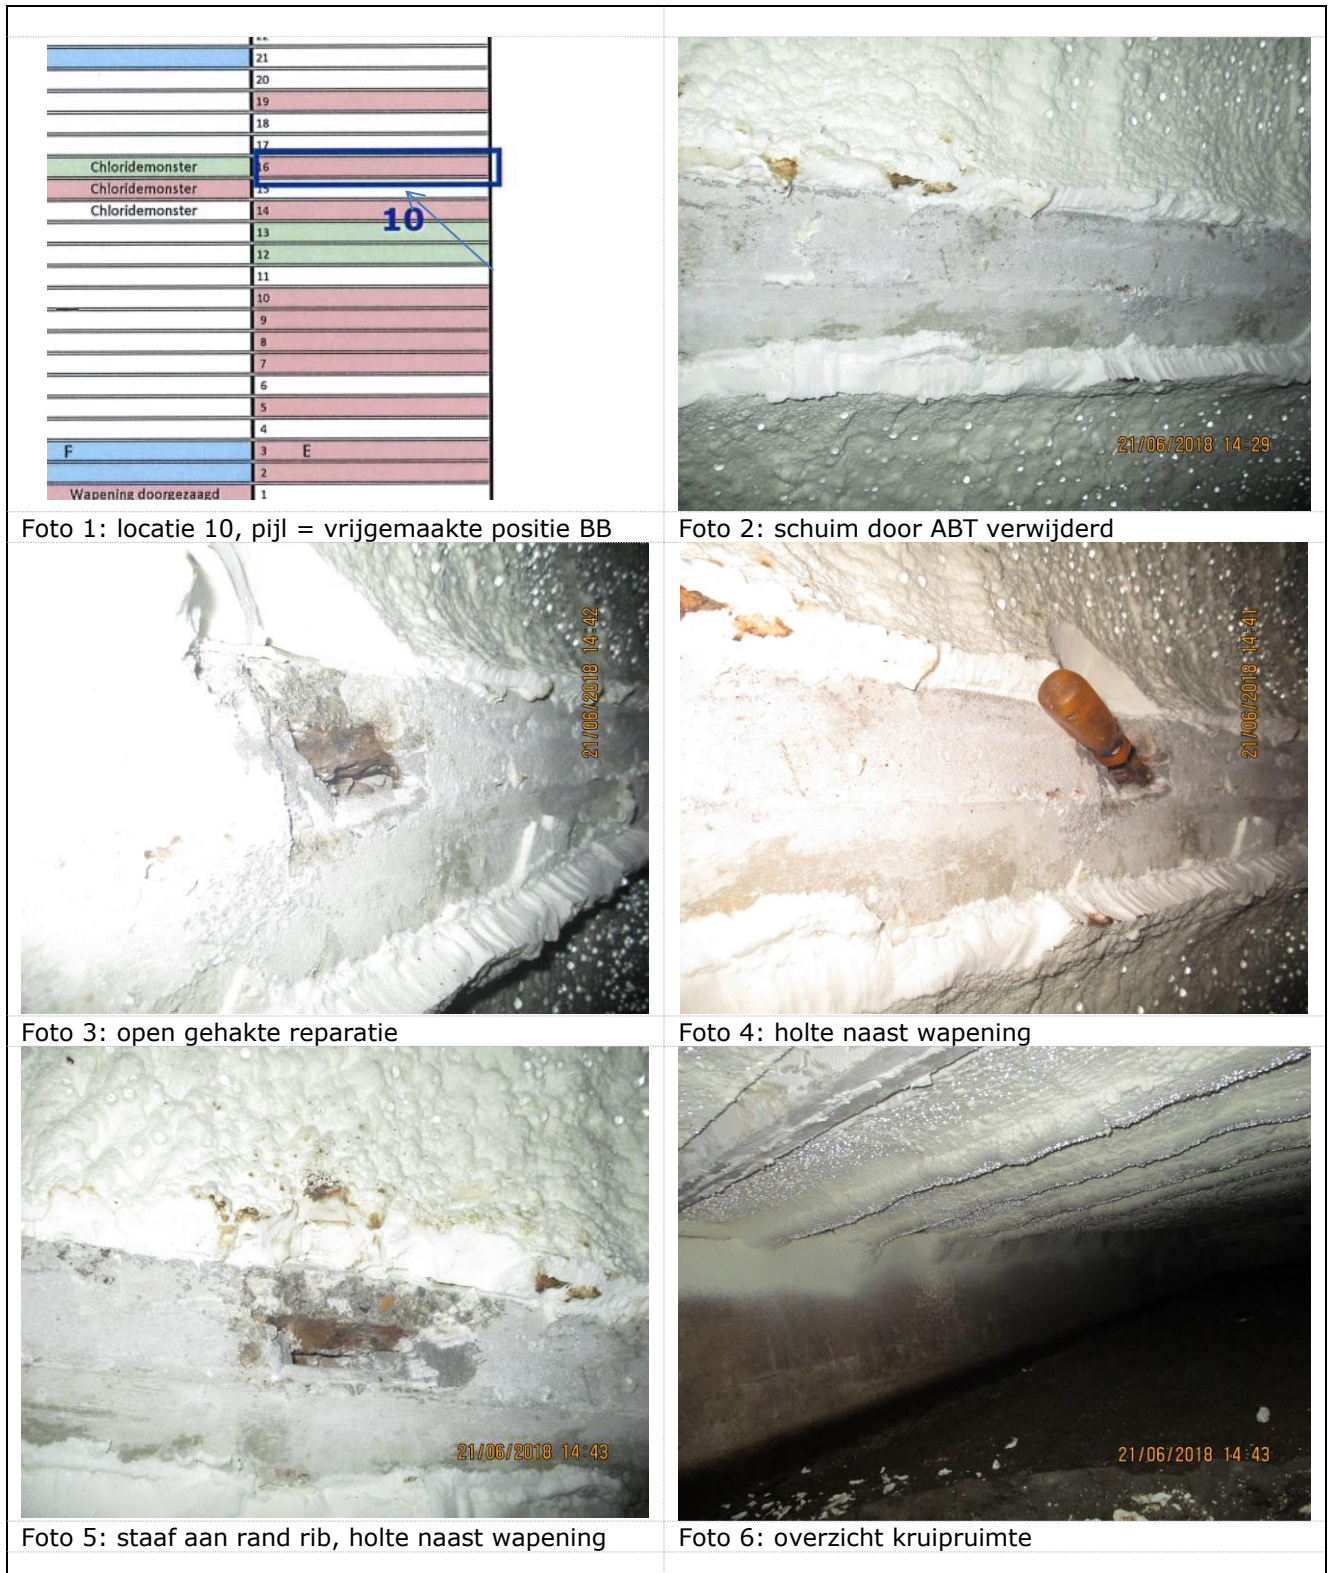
locatie 10, pijl = vrijgemaakte positie BB
